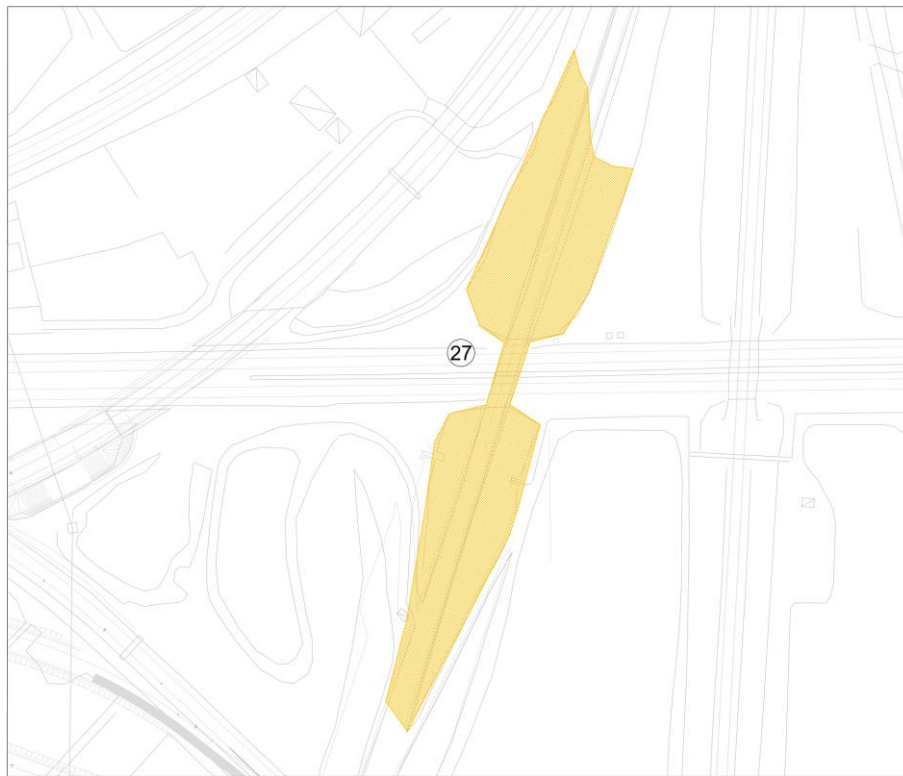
Stralcio planimetrico zona nuovo cavalcaferrovia IV03
